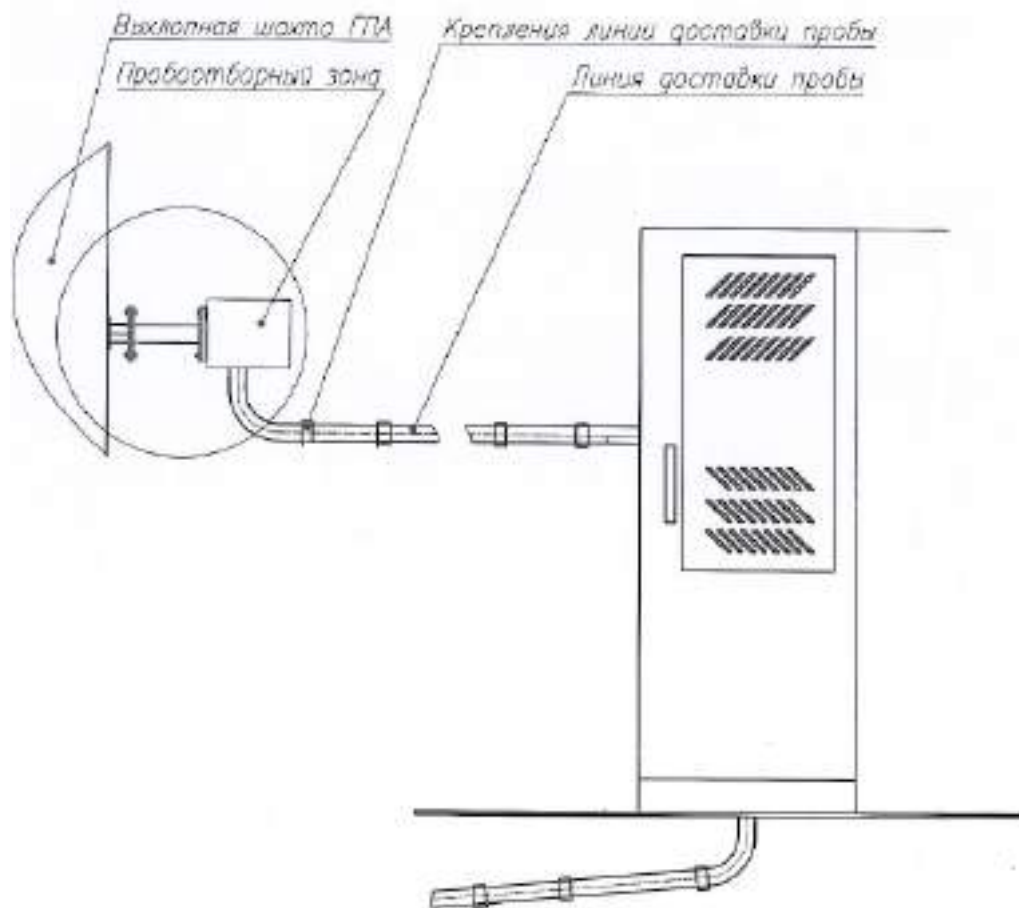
Примерная схема установки зонда, линии доставки газовой пробы и шкафа пробоотбора
